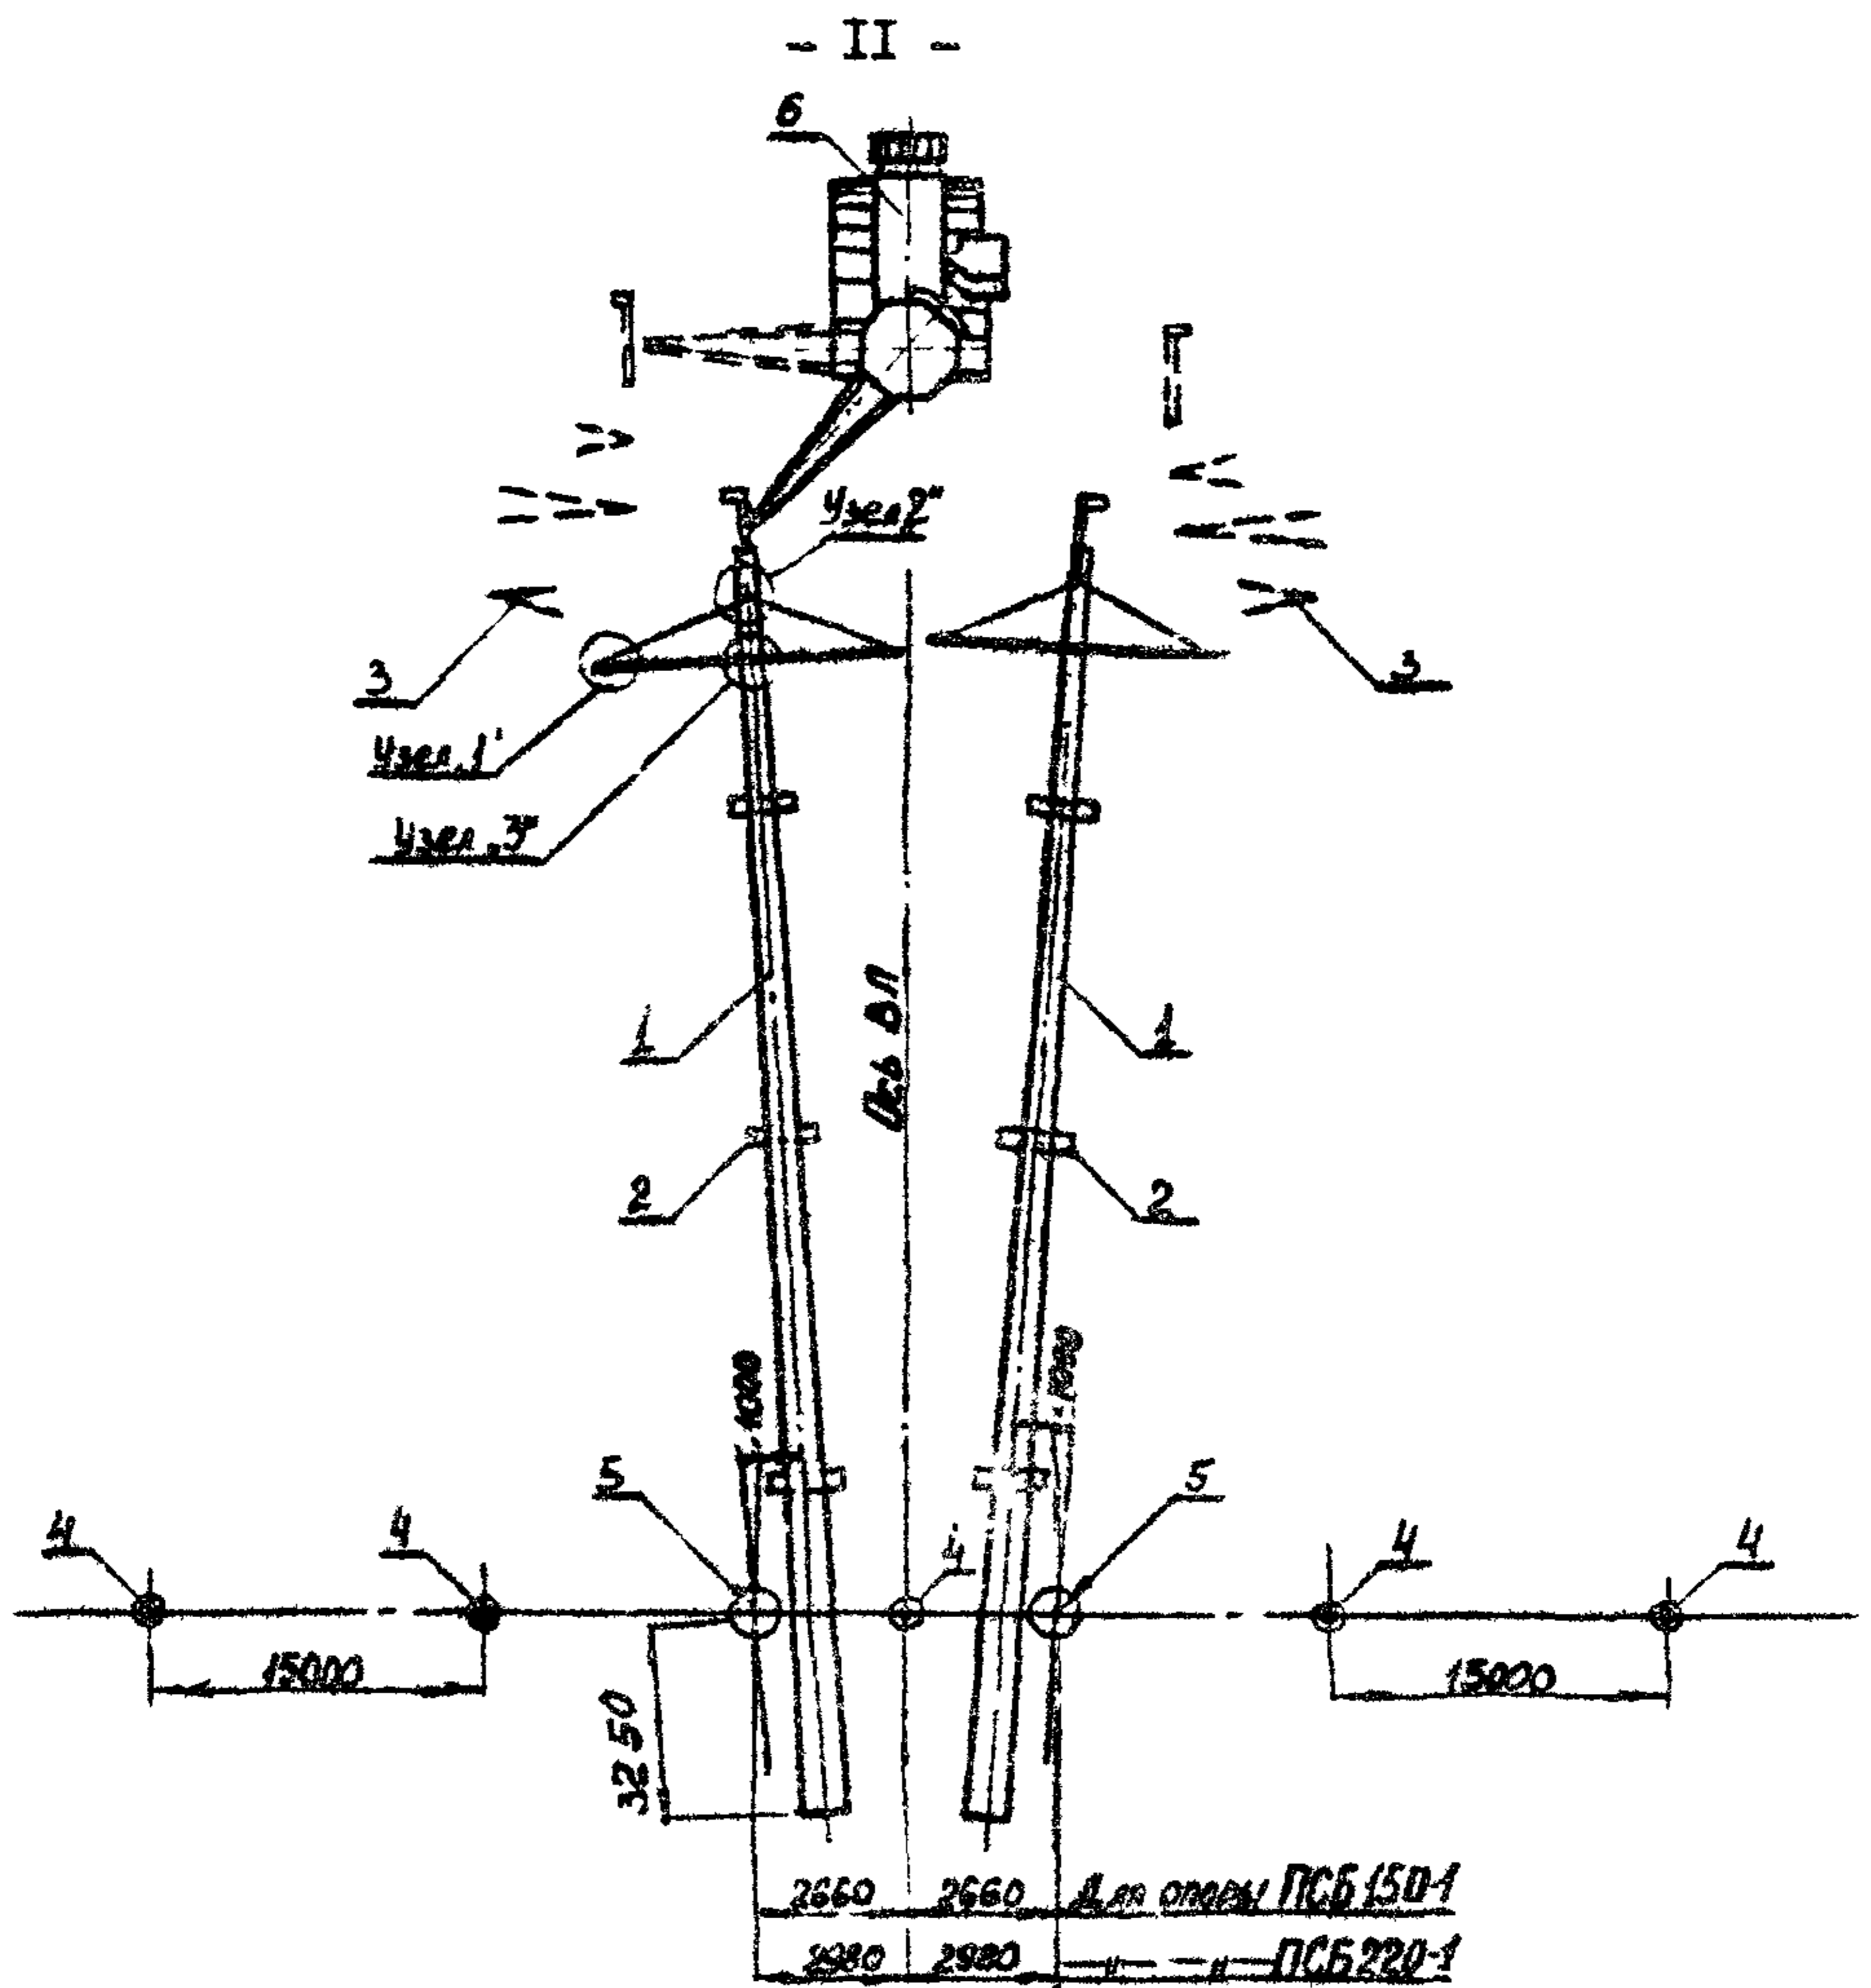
Схема выкладки стоек опоры и оснащение их металлическими деталями для подъема краном К-162 с стр. = 14 м
